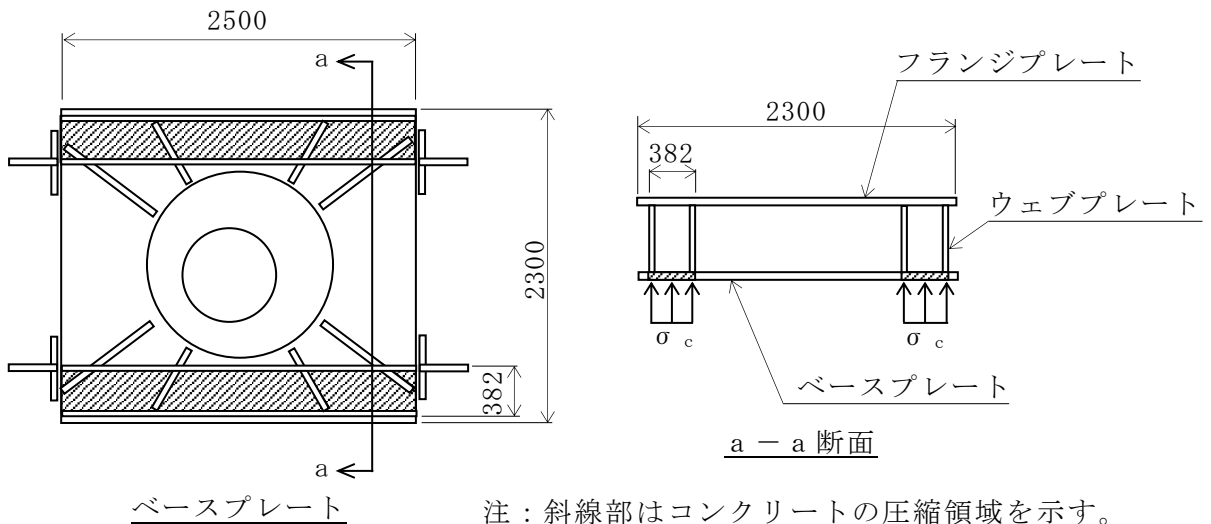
コンクリートに作用する圧縮力の概要図 (単位: mm)
